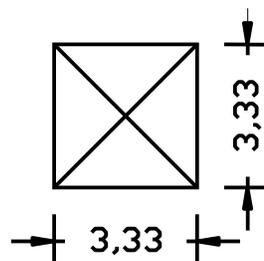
自屋凸頂往上 6m 之通訊鐵塔平面示意圖 單位 (m)
